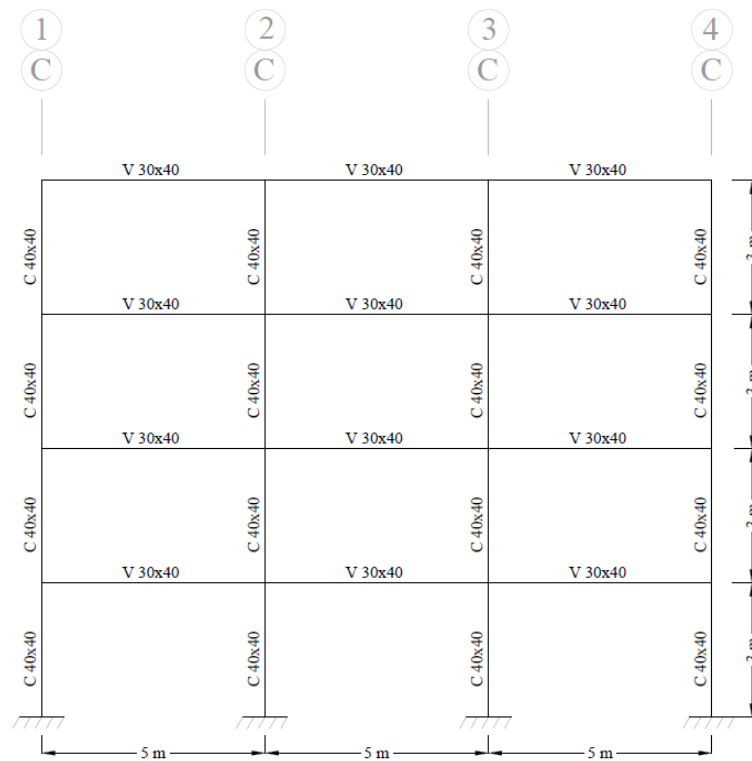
Dimensiones de los elementos estructurales del pórtico 2.
